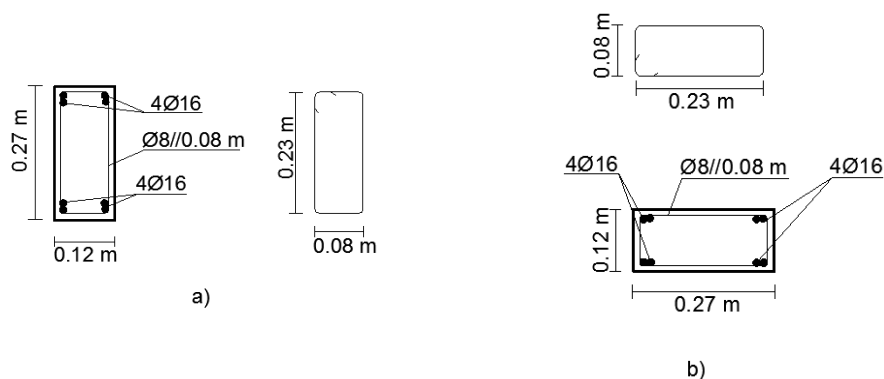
Corte transversal das peças P2 e P4, a) na viga e b) no pilar
